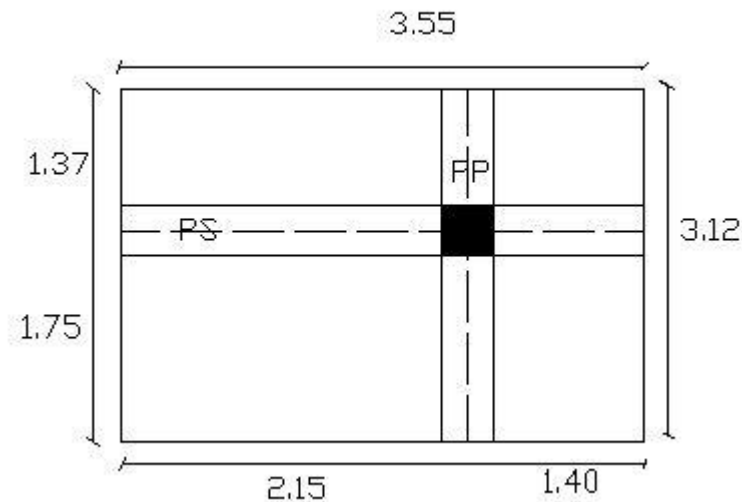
La section la plus sollicitée du poteau rectangulaire.
